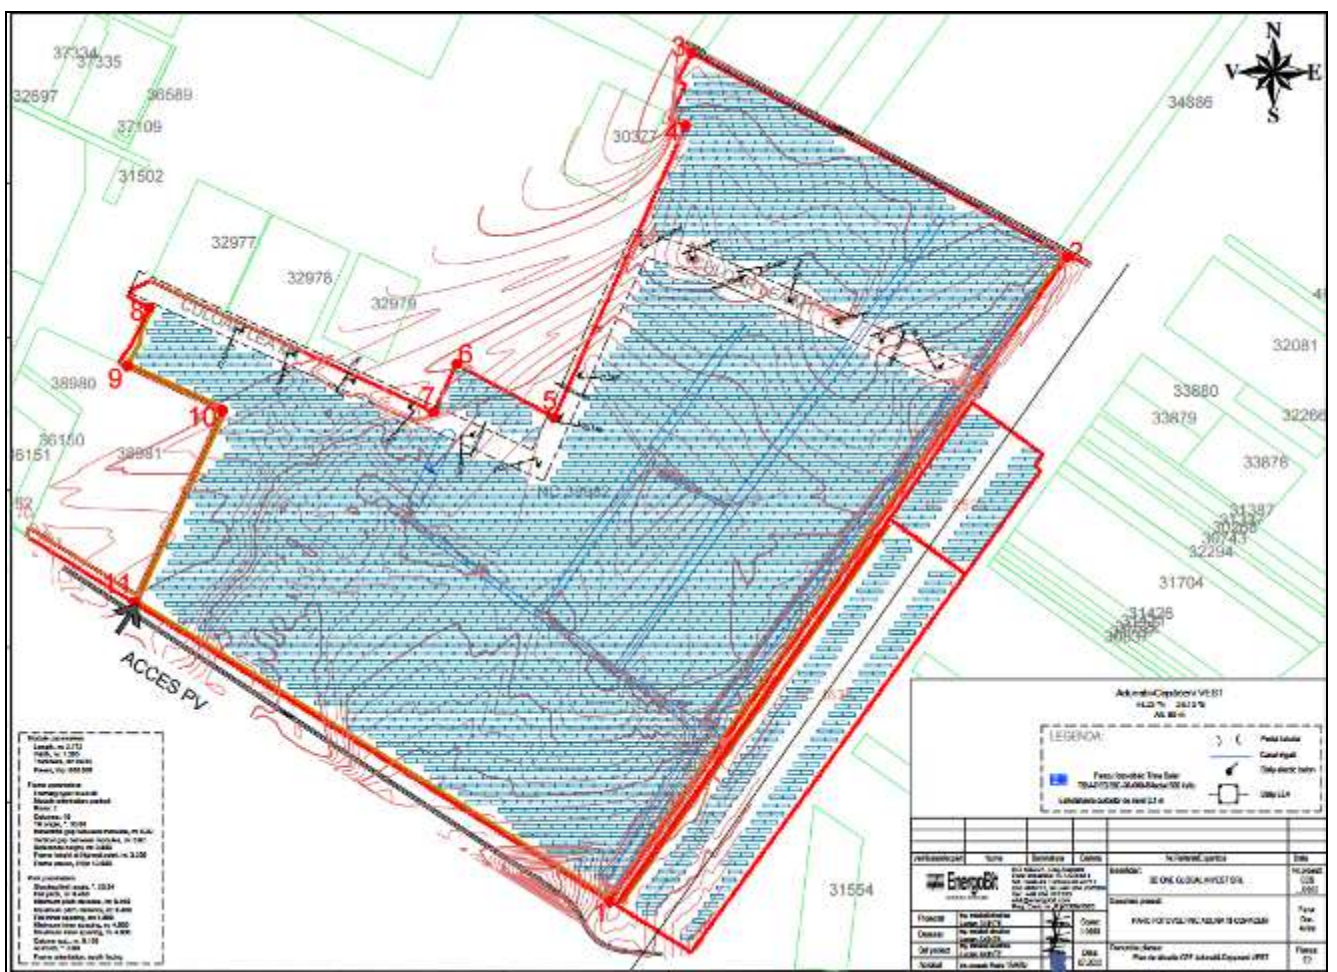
Plan de situatie CEF Adunatii-Copaceni VEST
